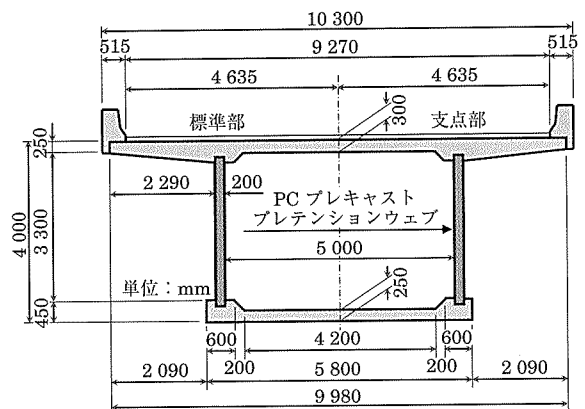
検討対象のPCプレテンウェブ箱桁橋の横断面図
